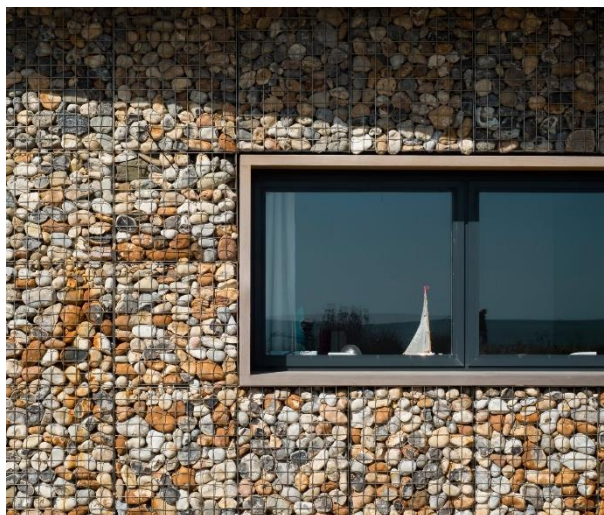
Dettaglio del prospetto della Shoreham Beach House
